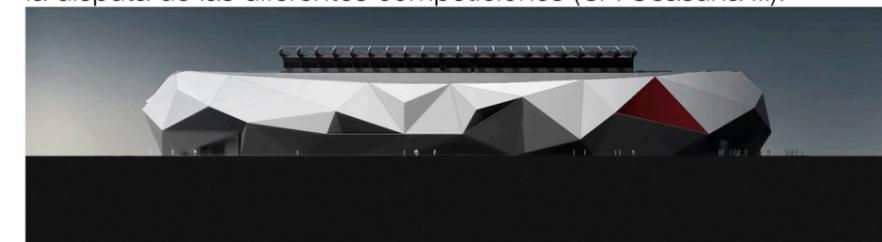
Renderización exterior, del alzado a pie de calle, de la propuesta.
